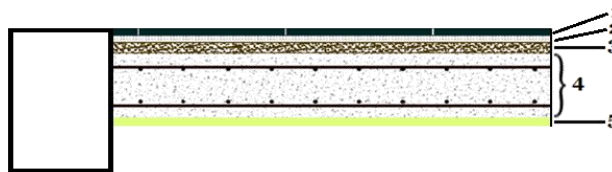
Coupe transversale d'un balcon à dalle pleine d'étage courant.
